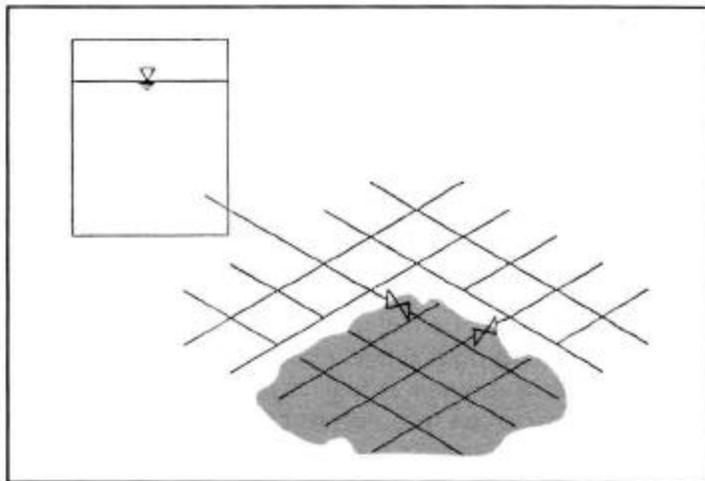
Aislamiento del área con válvulas sísmicas donde las tuberías son vulnerables debido a la alta licuefacción.
